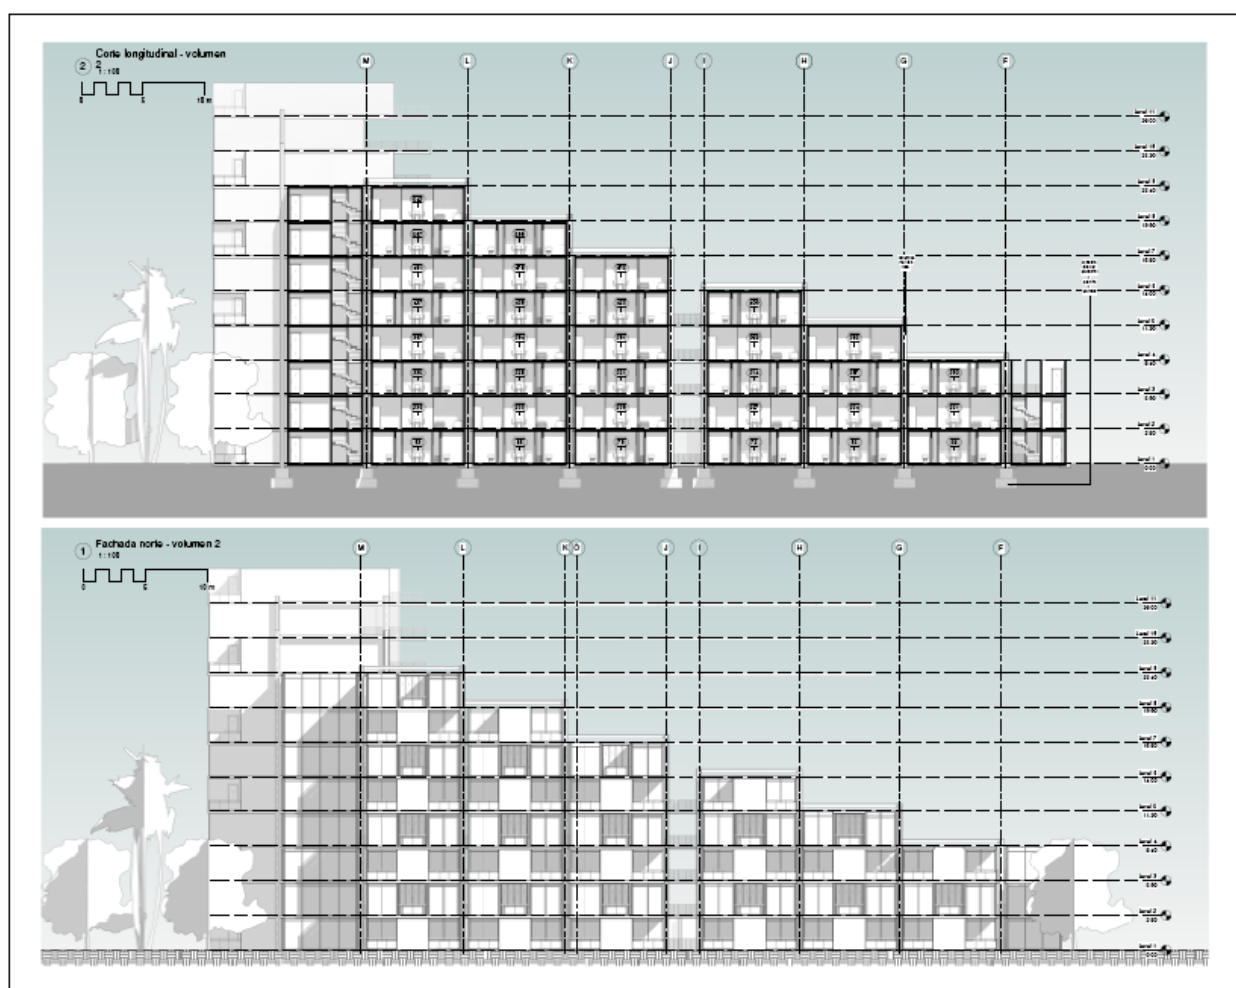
Anexo de Corte y fachada longitudinal del volumen 3 – Fuente propia.
